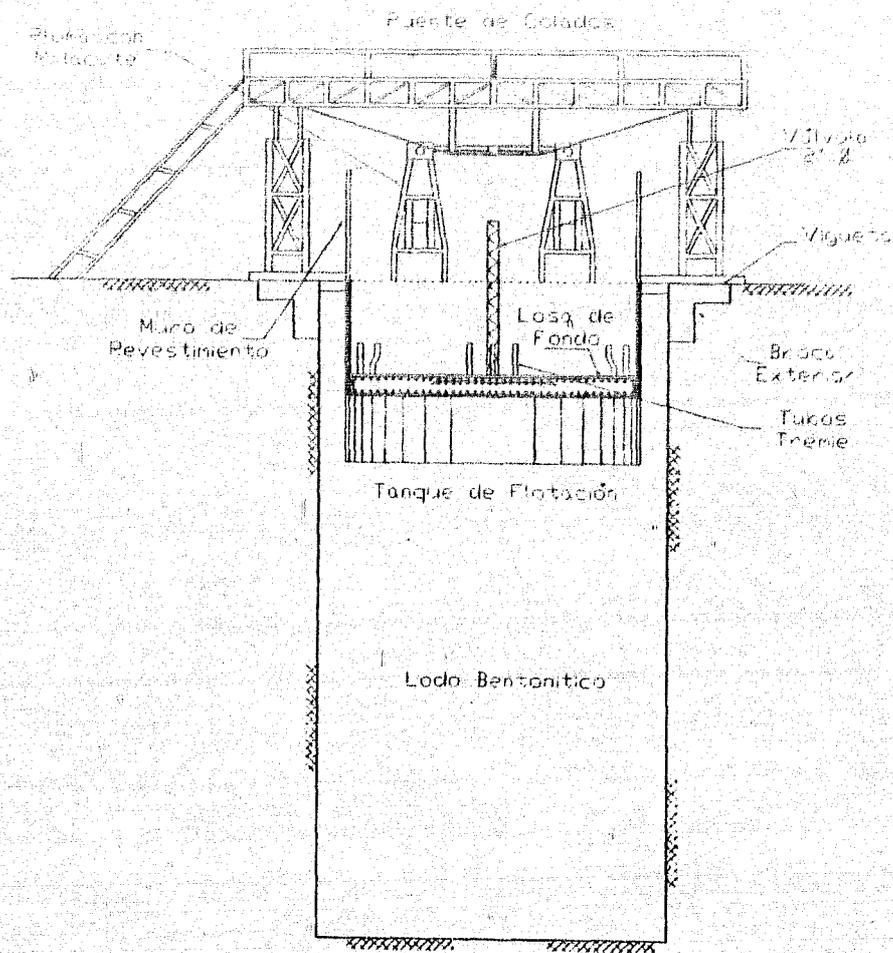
3ra Etapa de construcción de losaj de Fondo e Inmersión de la Lumbreros Colados:
